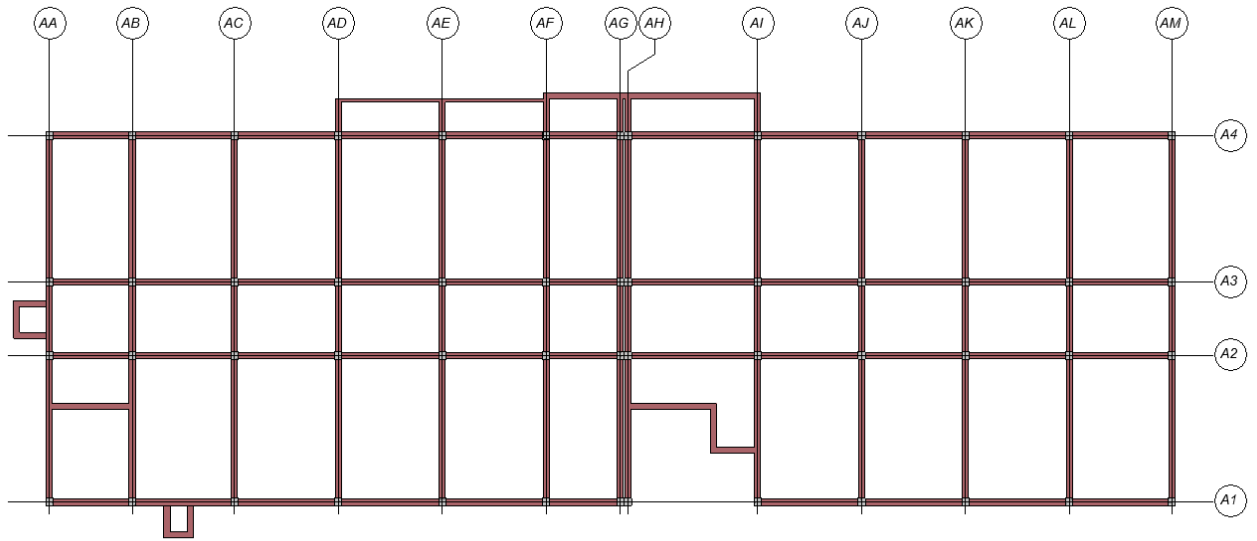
Vista en planta del forjado de la planta baja del Aulario
